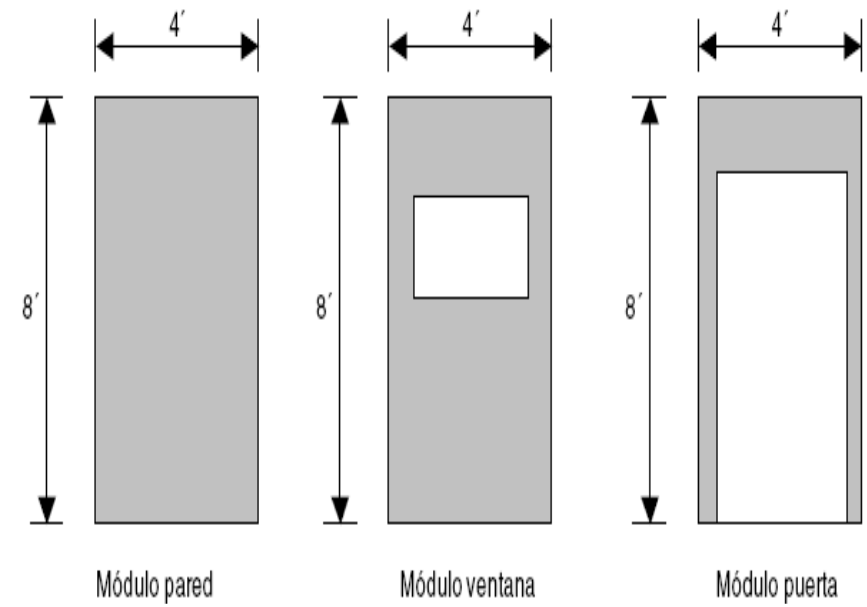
LAMINA COMPLETA, VANO DE VENTANA Y PUERTA
